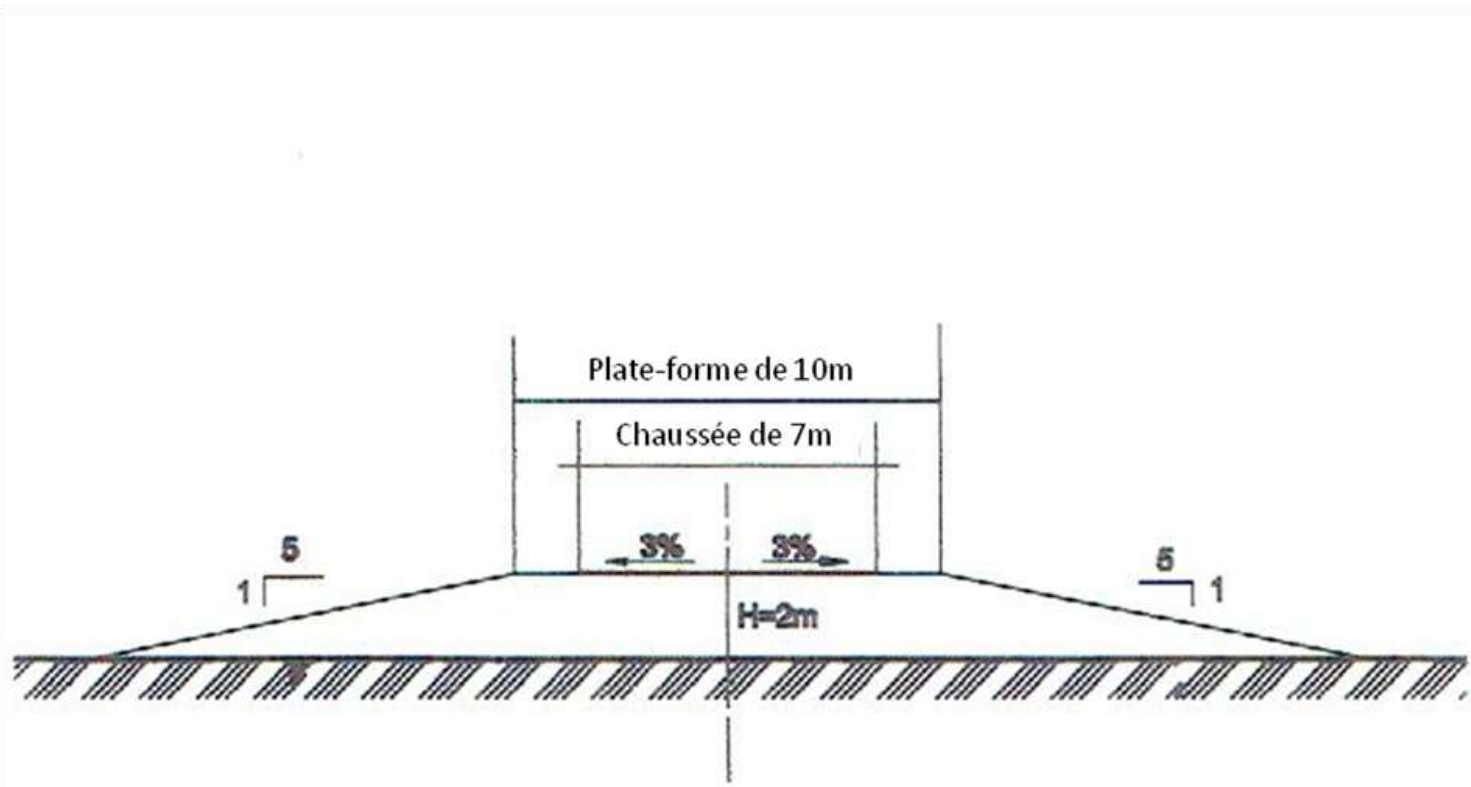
Profil d'équilibre de la route sans protection, la pente de la chaussée a été de 1/5 (ECH : 1/200)
